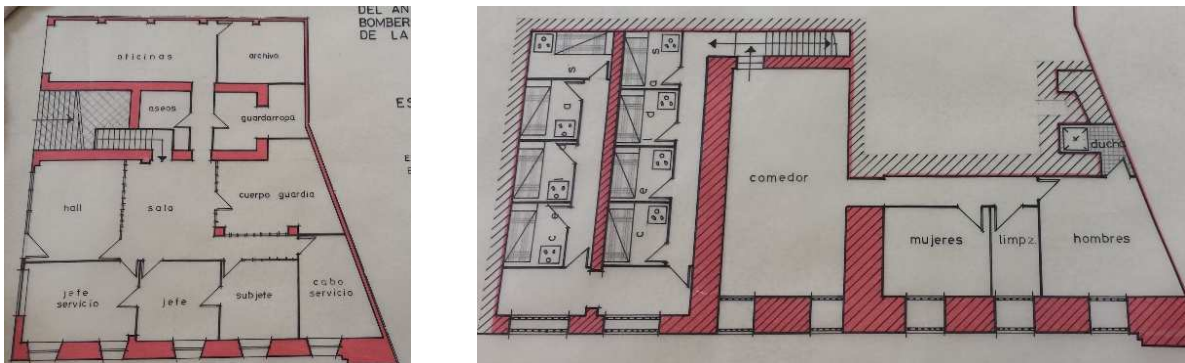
Imagen izquierda - Distribución planta baja. Imagen derecha - Distribución planta sótano. Fuente: Pérez Aracil, Santiago (1963). AHME – P100/16.
